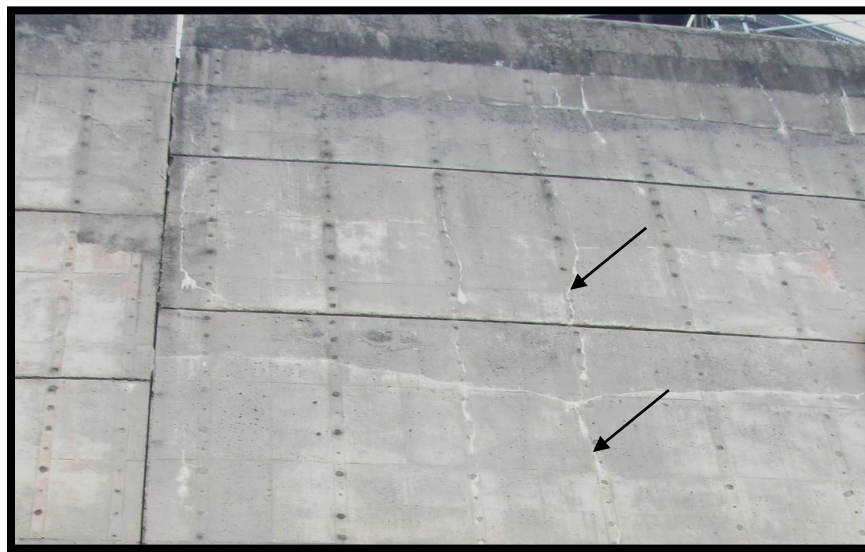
Fotografía detalle del tipo de fisuración en la TE-2940 (Fuente: el autor).
